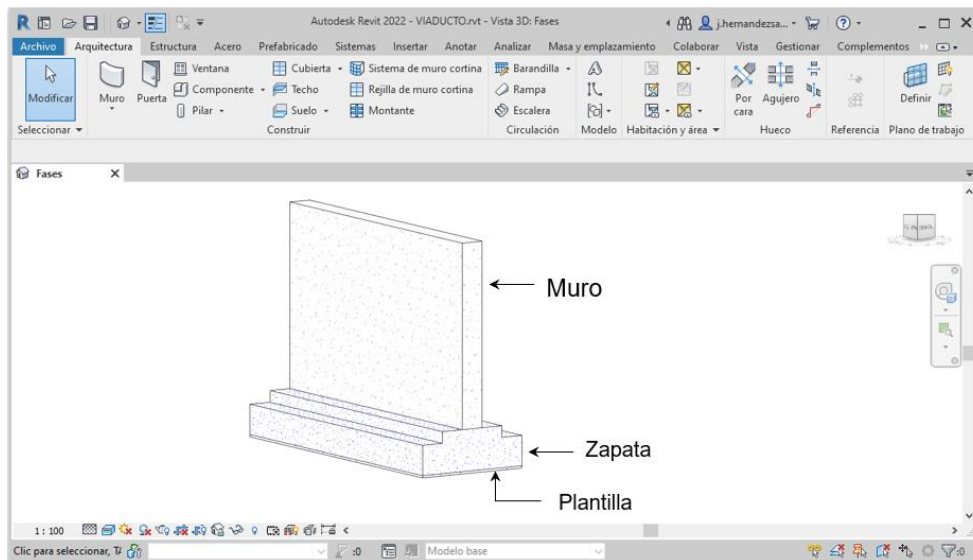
Modelado de zapatas y muros de Caballetes con Revit. Fuente: Elaboración propia
